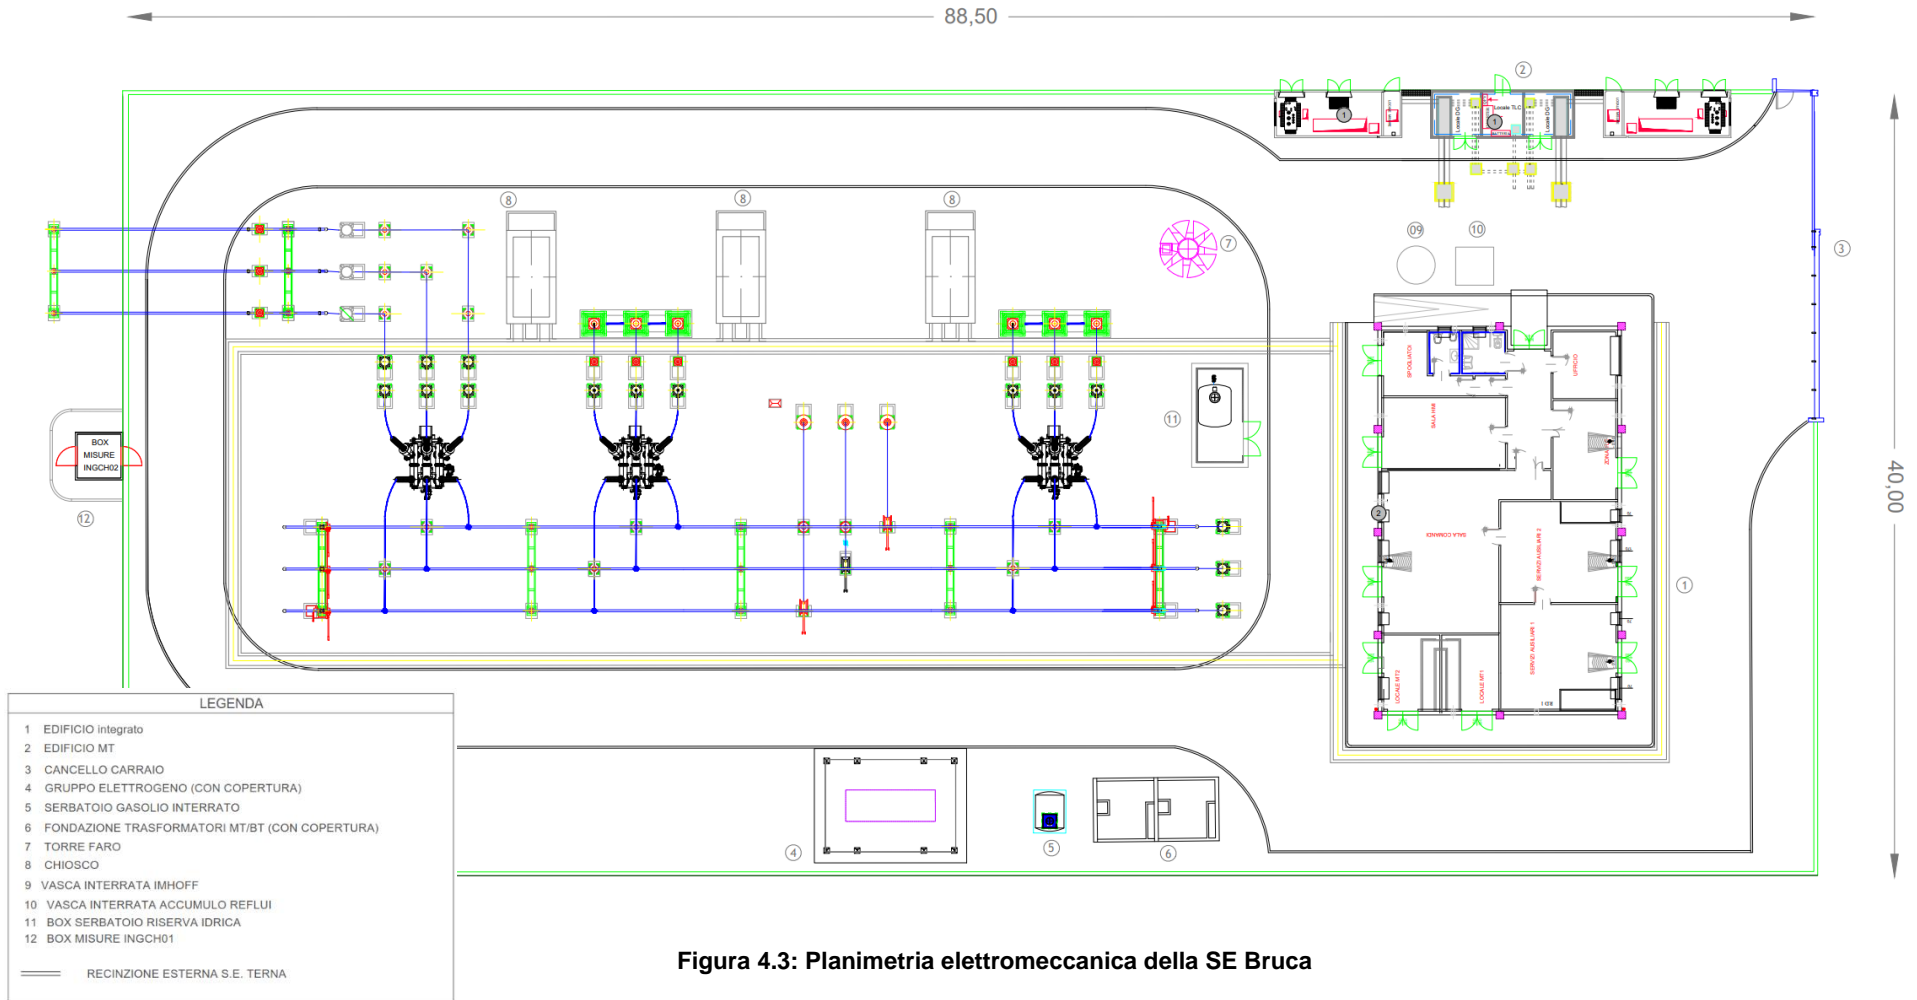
Planimetria elettromeccanica della SE Bruca
